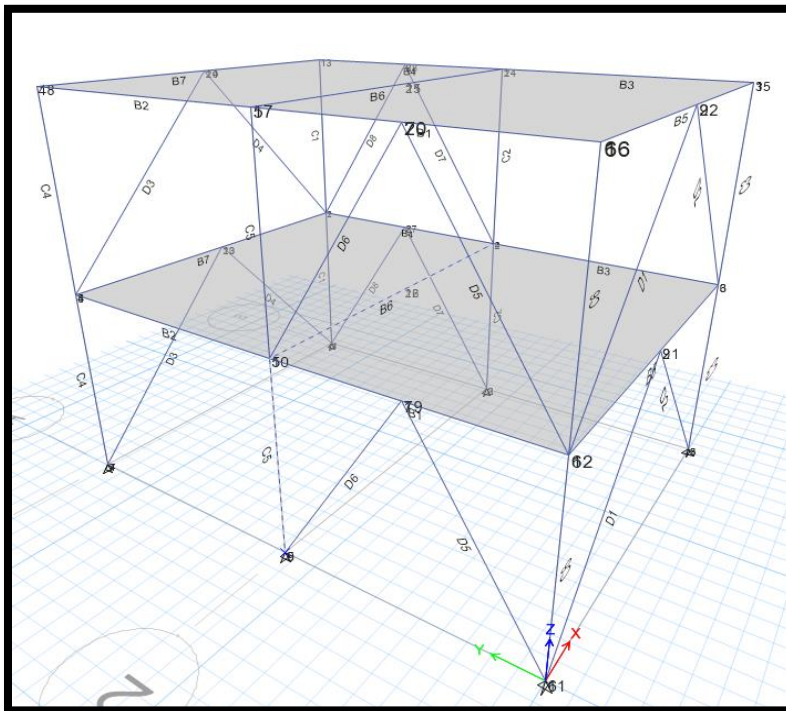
Identificación de uniones , apoyos , vigas y columnas
